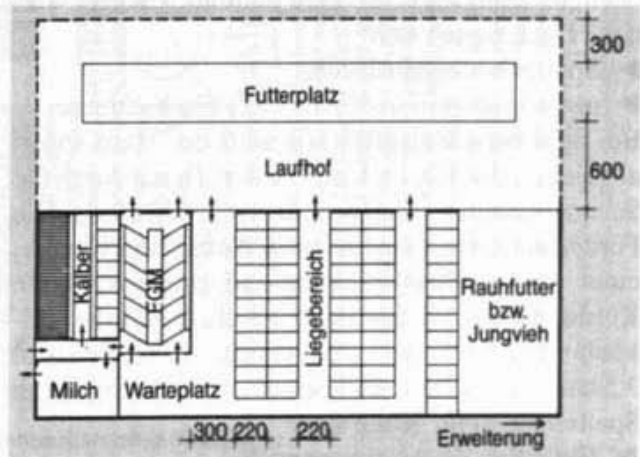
Grundform des Liegeboxenstalles mit Laufhof (Maße in cm).
